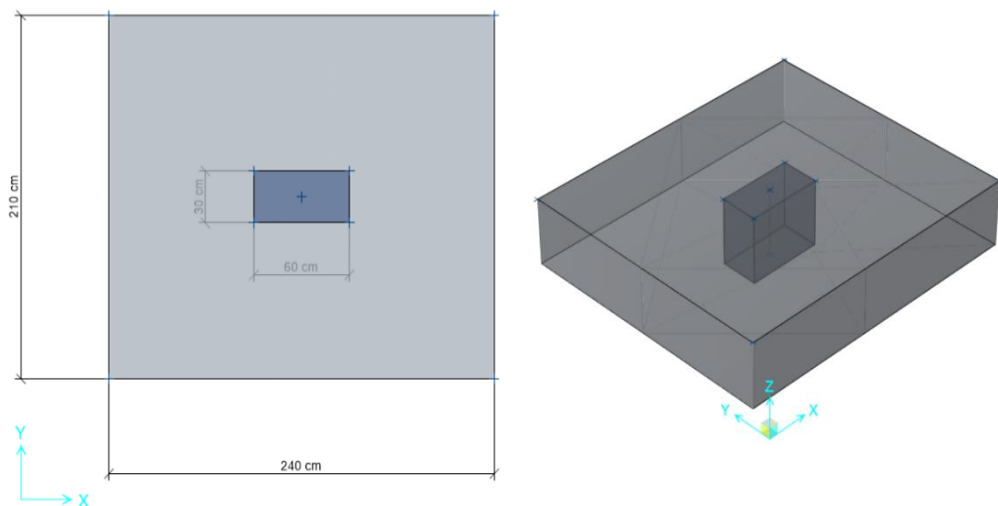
Modelo estructural de la cimentación vista en planta y en 3D (Zapata-relleno fluido)
